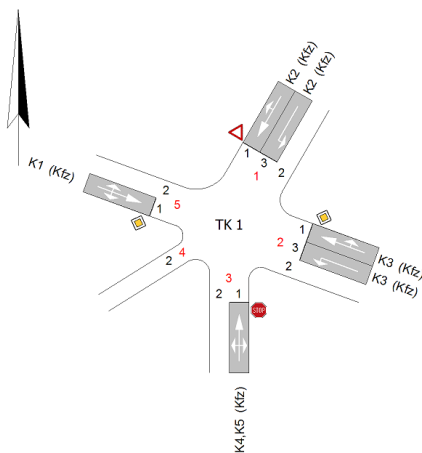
Knotenpunktskizze 1 im Bestand (Signallageplan in Anlage 9)
